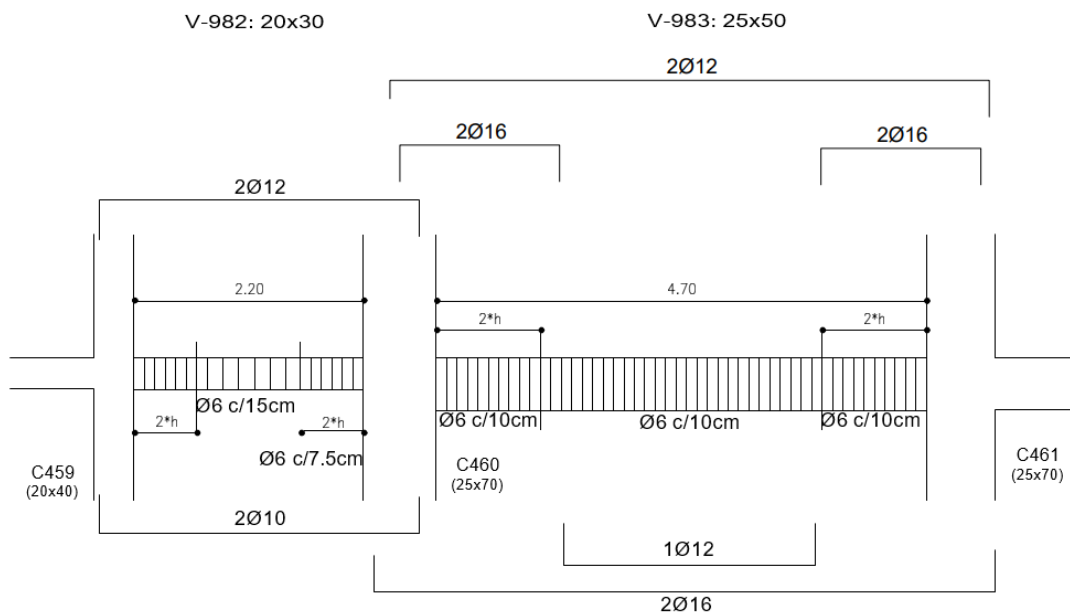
Esquemas de armaduras - Vigas 982 y 983
